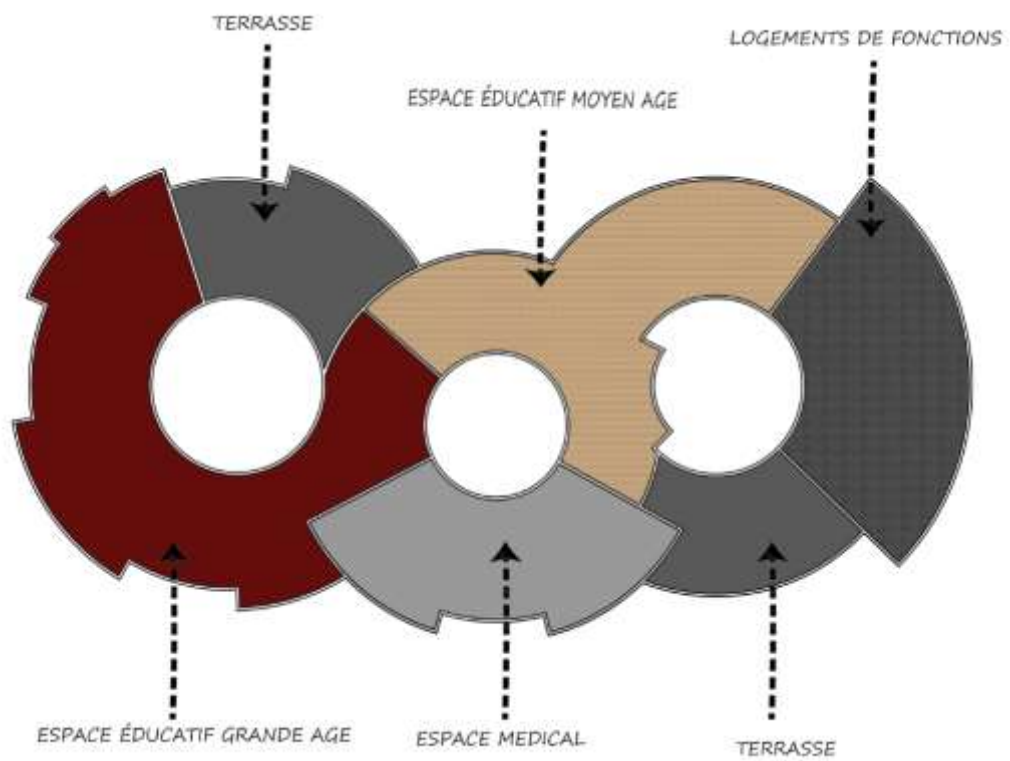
Schéma de plan de r+1 (Source : Auteurs)
